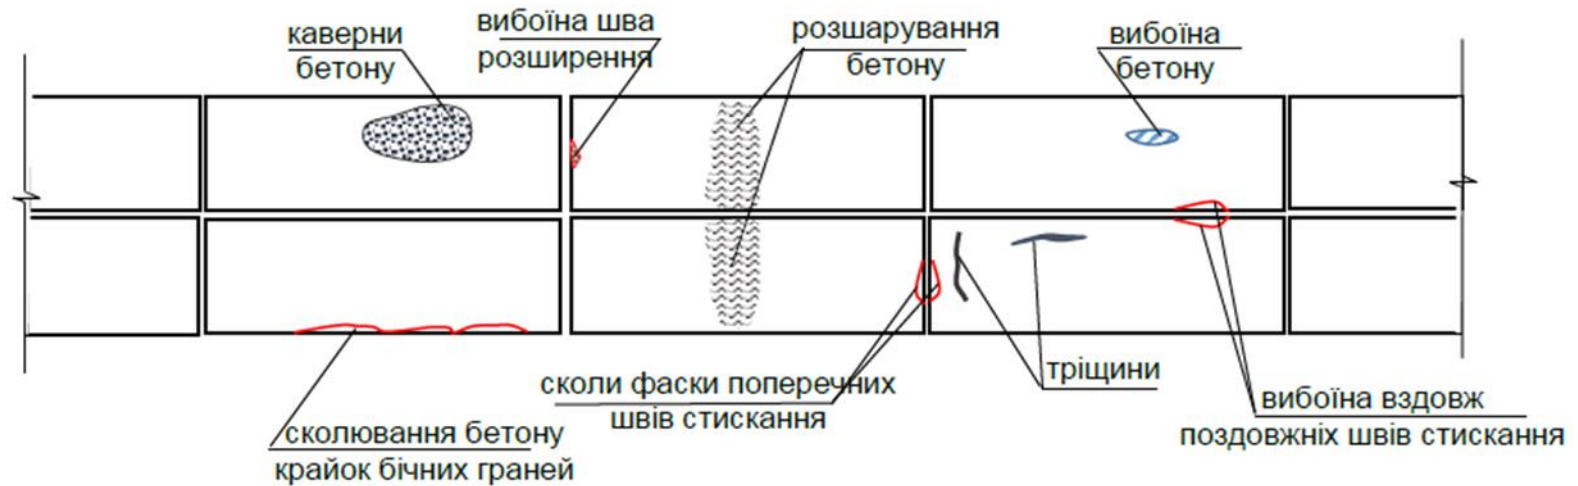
Характерні дефекти та пошкодження бетонної поверхні цементобетонного покриття
